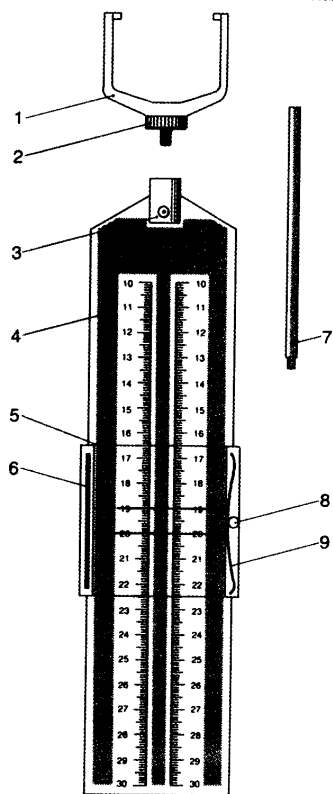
Измерительная шкала, которая подвешивается: 1 – скоба для подвешивания; 2 – контргайка; 3 – резьбовая втулка для крепления скобы; 4 – измерительный флажок со шкалой; 5 – бегунок (движок); 6 – полоса скольжения бегунка; 7 – калиброванный соединительный элемент изменения высоты подвешивания; 8 – регулировочный винт пружины; 9 – пружина движка
